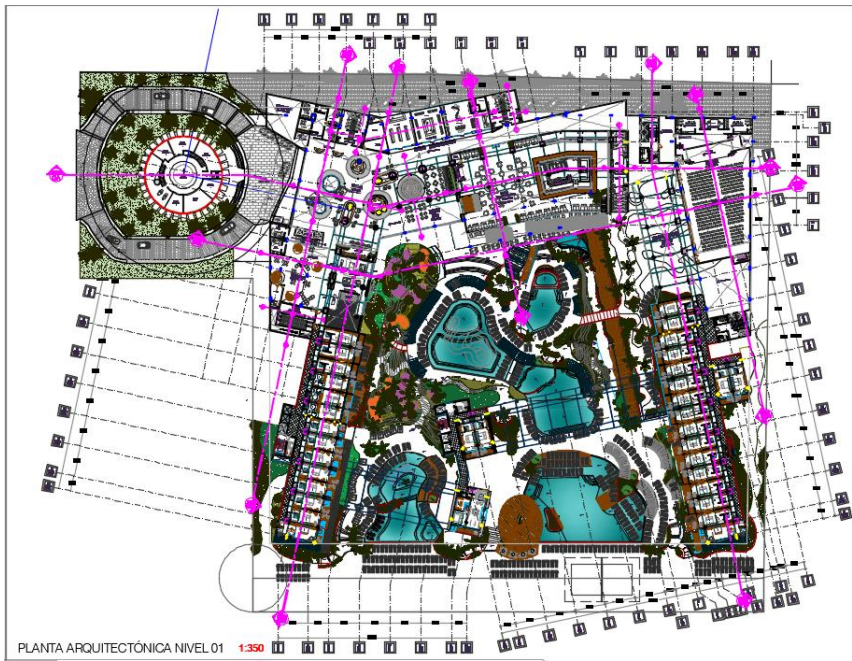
, Plano de Planta Hotel Crown Paradise Riviera Maya Cancún
